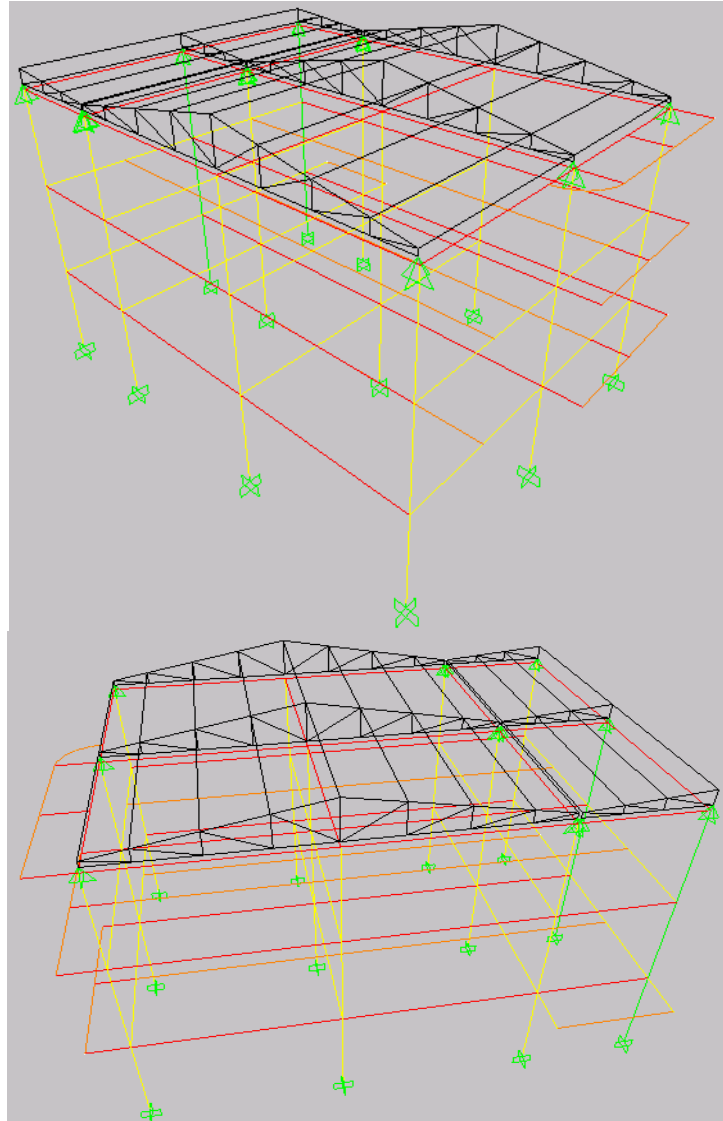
Vista general en planta e inferior del bloque dos modelado con secciones
